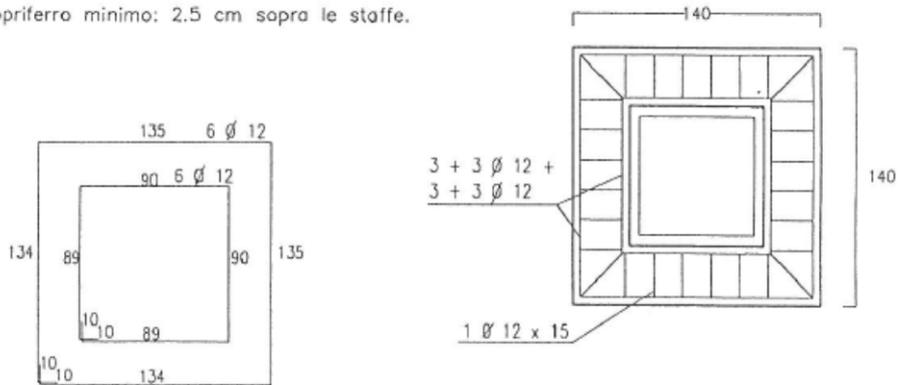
Esempio di plinto di fondazione gettato in opera (anno 2002)
